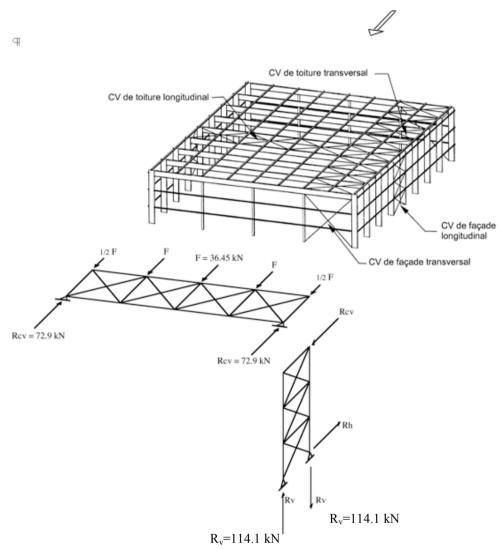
Cheminement des forces du vent longitudinal aux fondations
